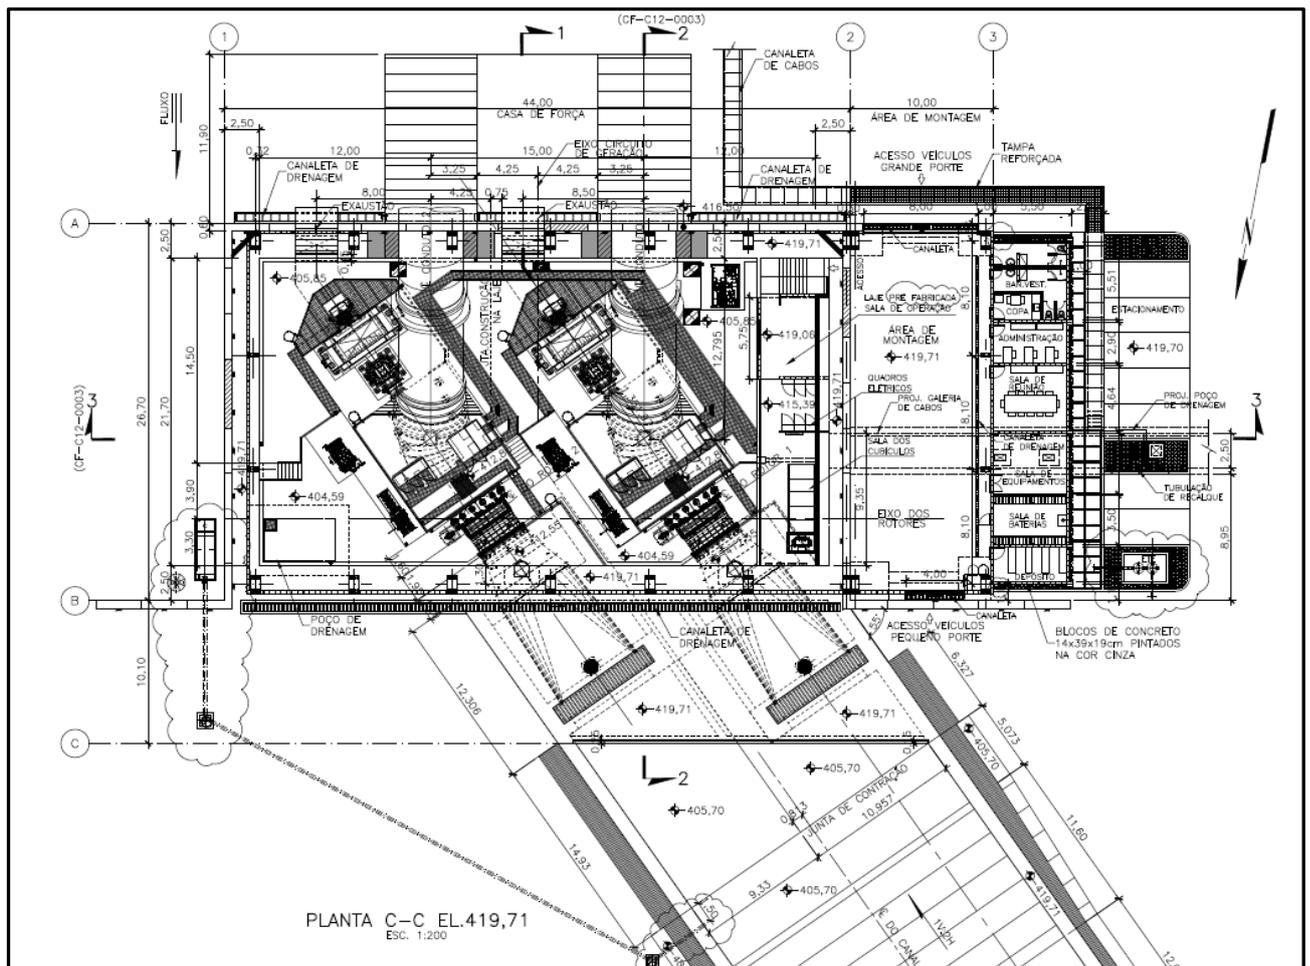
Arranjo Casa de Força – Planta (extraído do PJ1162-E-E00-CF-DE-0002-3C).
